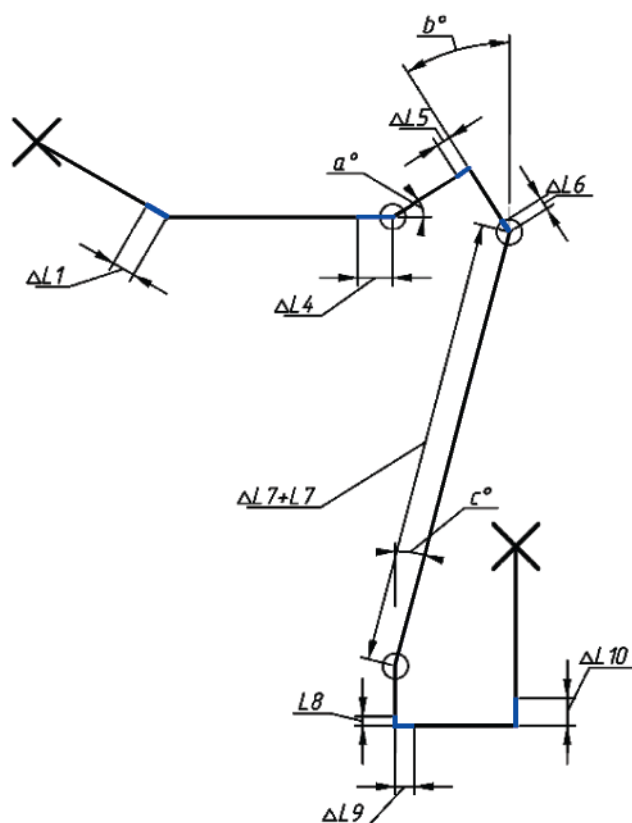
б. Расчетная схема трубопровода с указанием температурных удлинений участков
